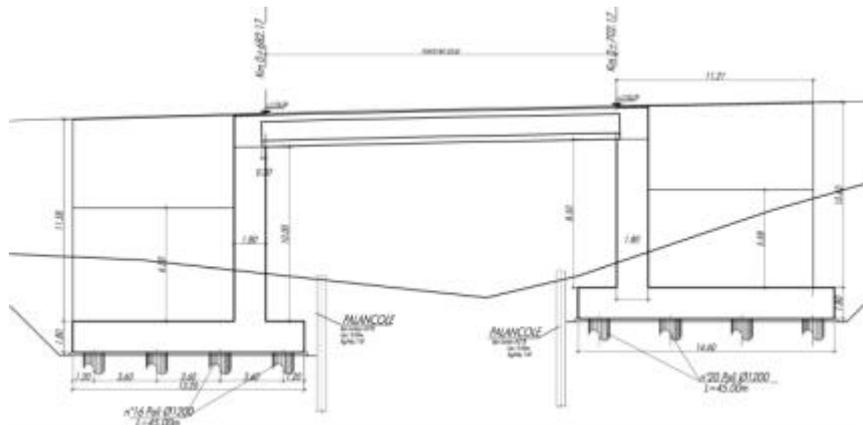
Sezione Longitudinale del Ponte Ries (ns. elaborazione da tavola T01VI03STRDI01_A_Pianta impalcato, sezione longitudinale e dettagli del progetto definitivo).
